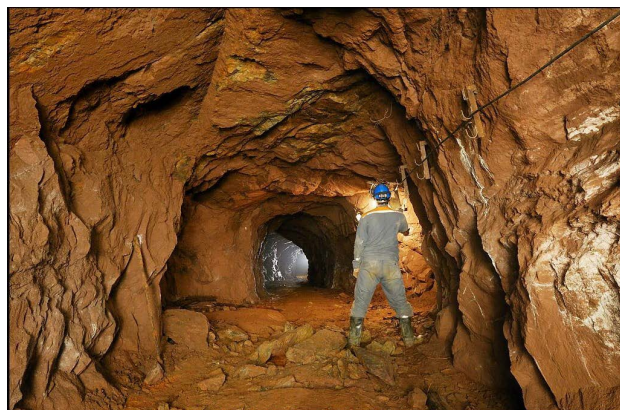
Ústí dopravního překopu v areálu Kovohutí Mníšek (dříve Hrudkovny Mníšek). Foto M. Korba, říjen 2010.
